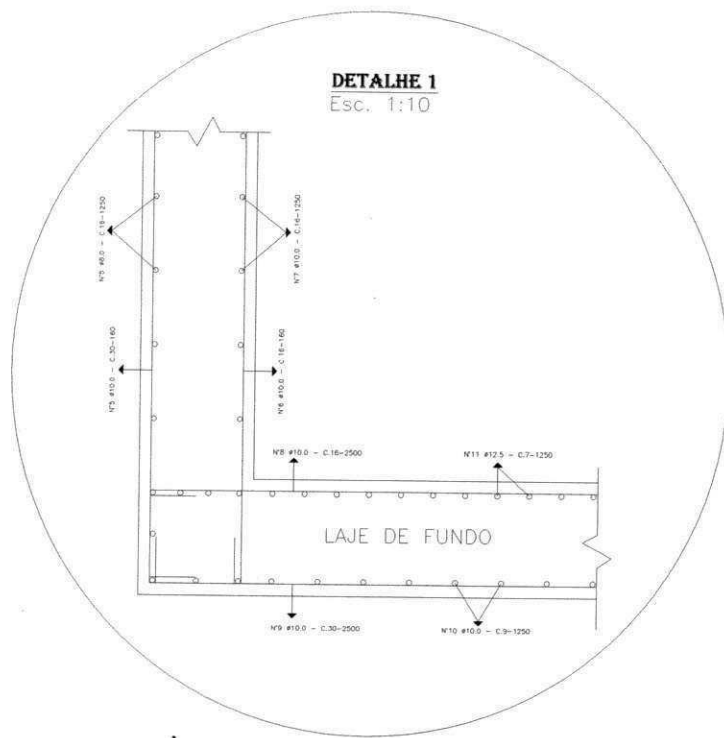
Detalhe da Ferragem da laje de fundo da piscina
